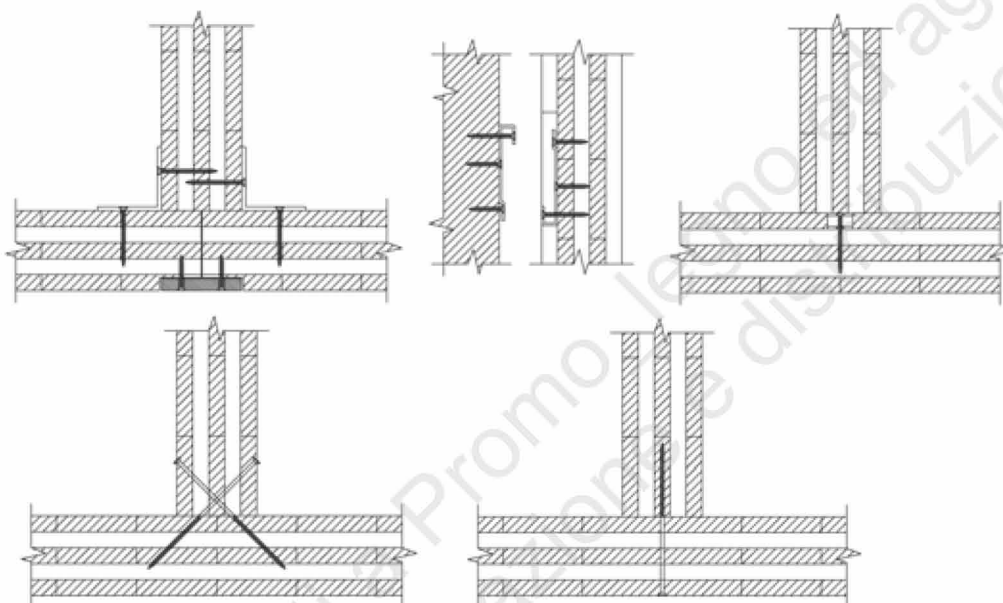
Collegamento parete – parete: alcune soluzioni costruttive
